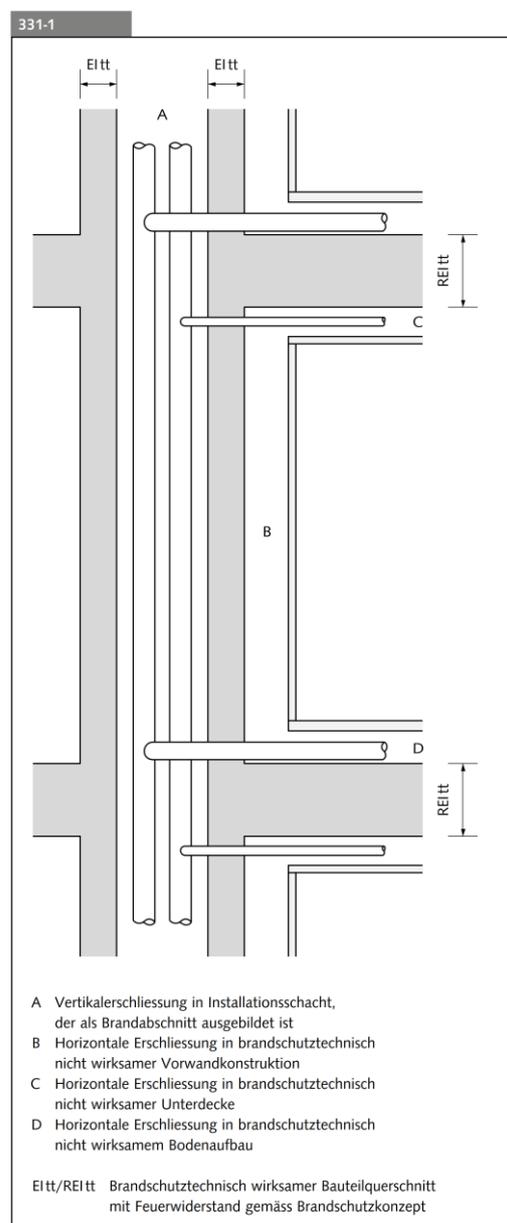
Horizontale Erschliessung in brandschutztechnisch nicht wirksamen Installationsebenen (Abbildung 331-1 gemäss [2])
